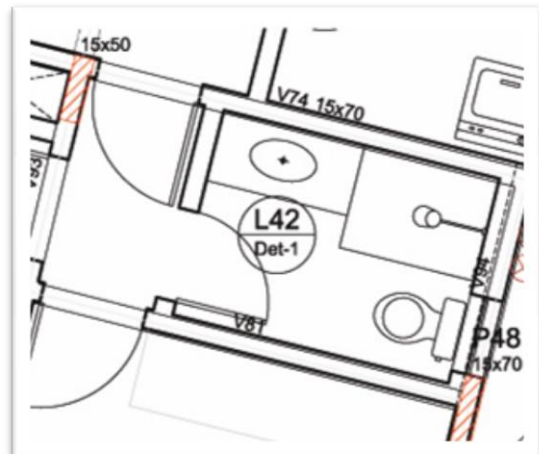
Planta baixa desalinhamento de viga com parede.
